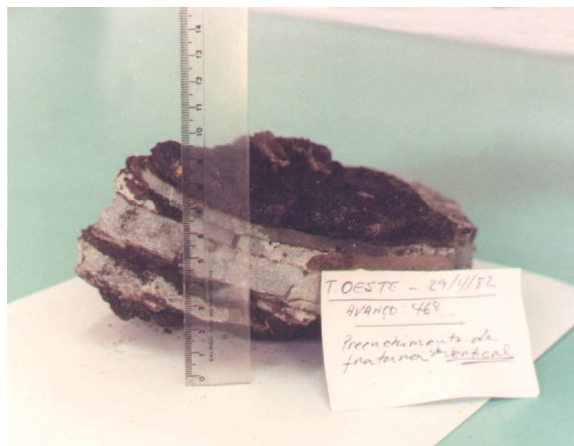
Camadas de injeção de calda de cimento em solo aluvionar de São Paulo consolidado por injeção (Apud. Guimarães, J.D.)
